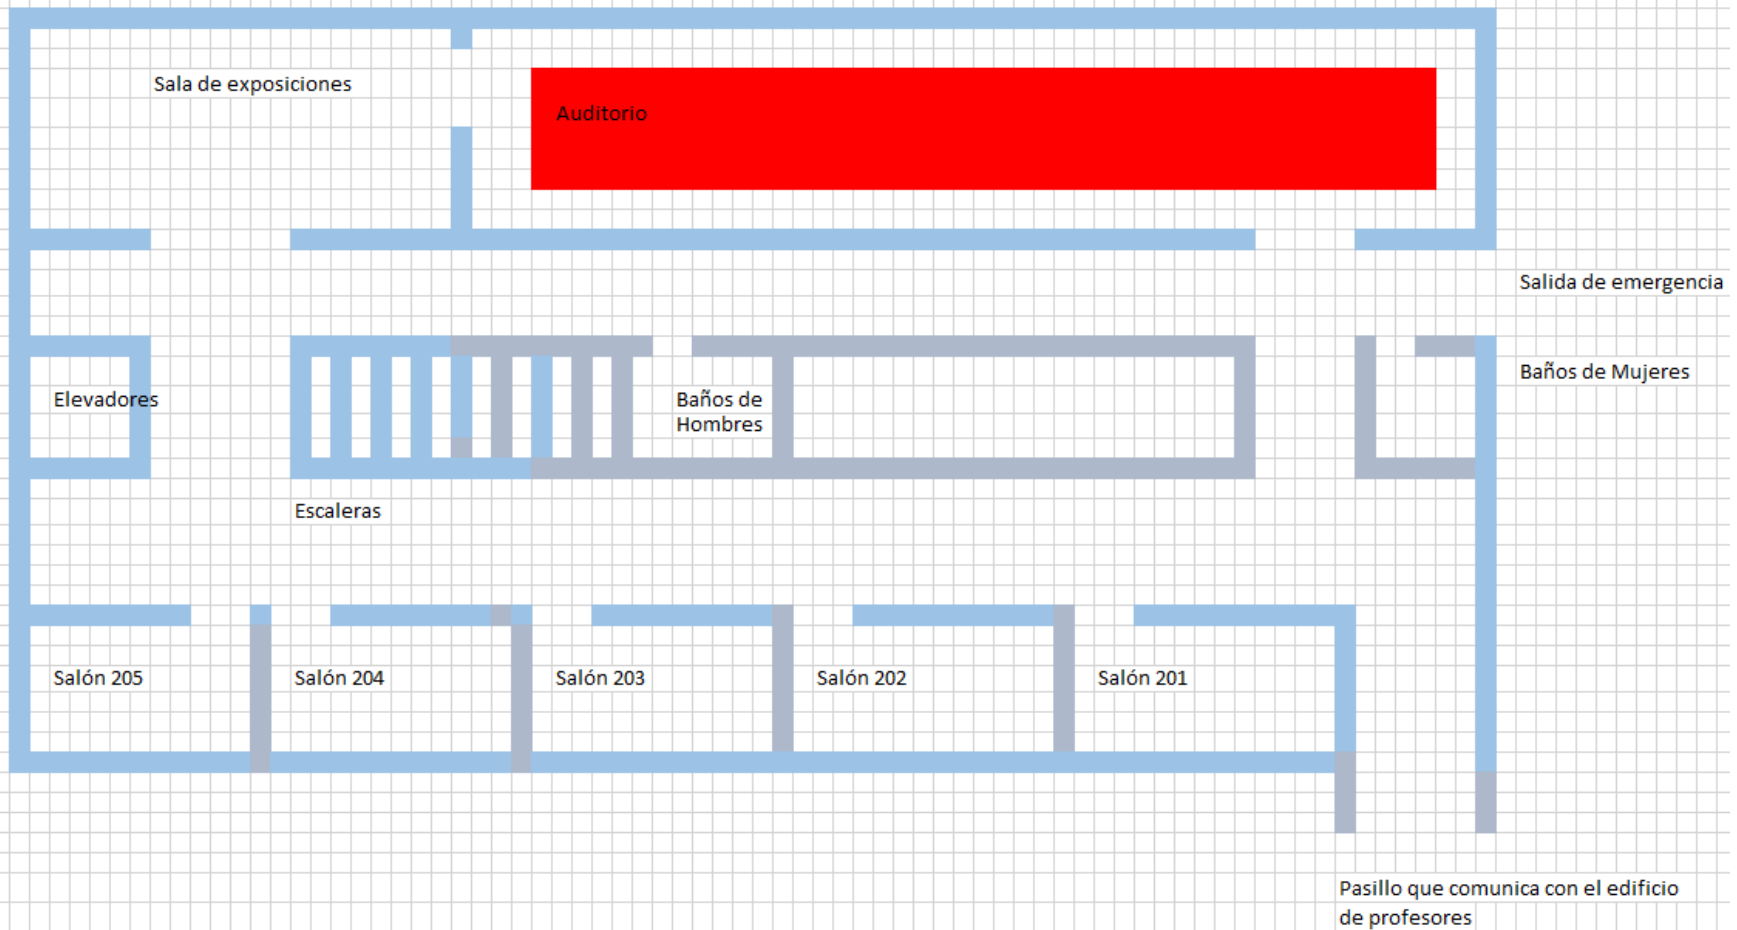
Croquis del plano de las actividades de la feria de la salud del edificio en plantel Centro Histórico 1er piso, fuente elaboración propia
